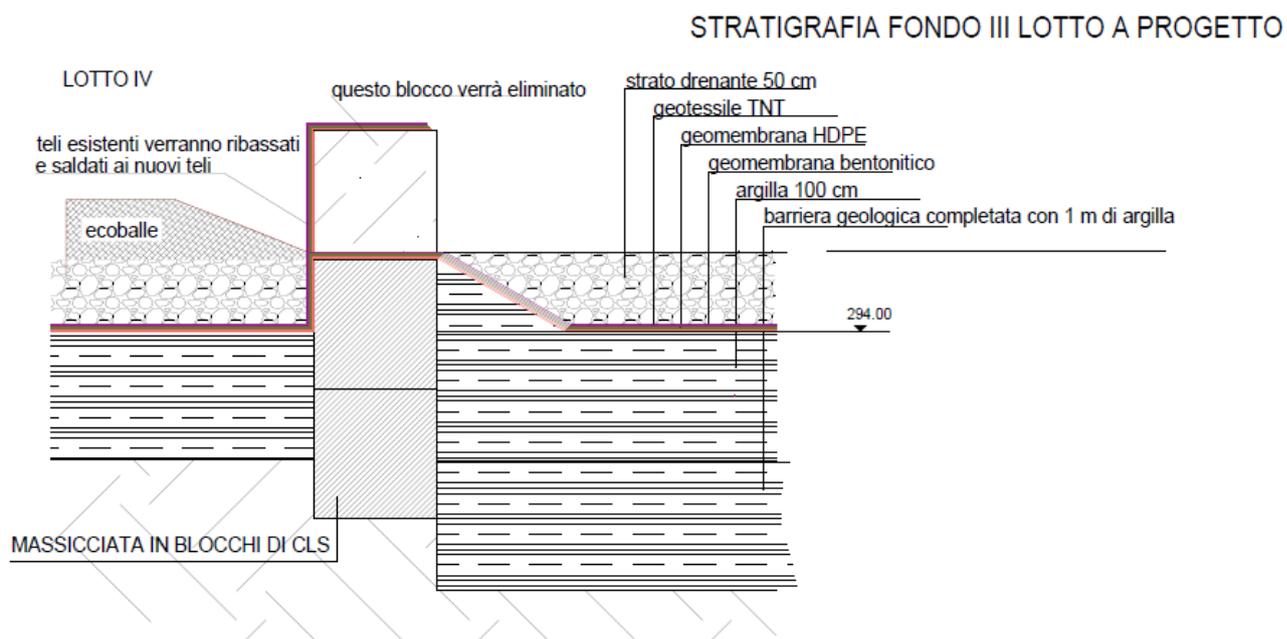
Schema di collegamento in corrispondenza del fondo del lotto IV e del lotto III a progetto
